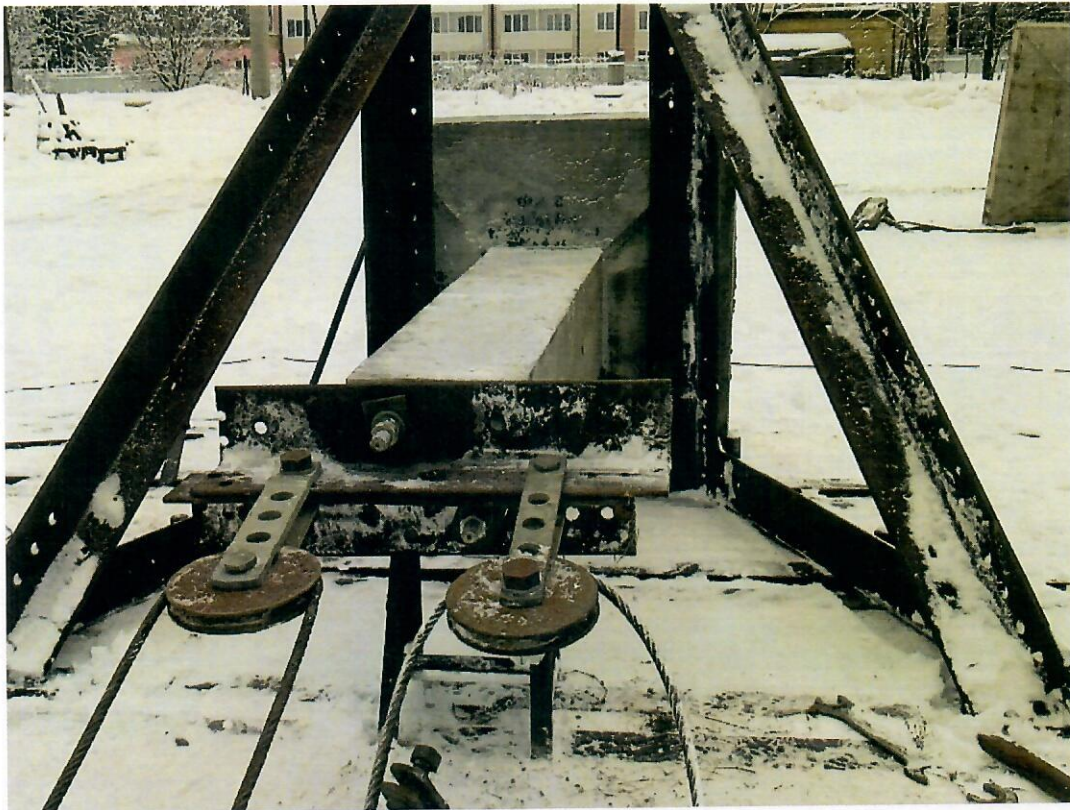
Фундамент Ф2-2, установленный на стенде
